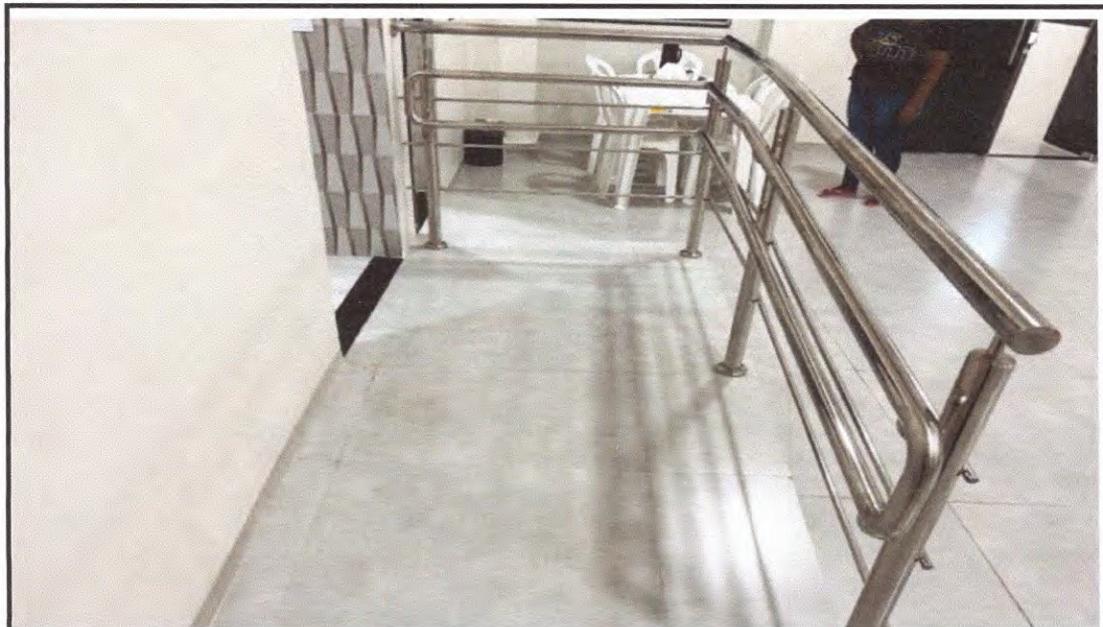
Rampa de acessibilidade para acesso ao banheiro PCD.
